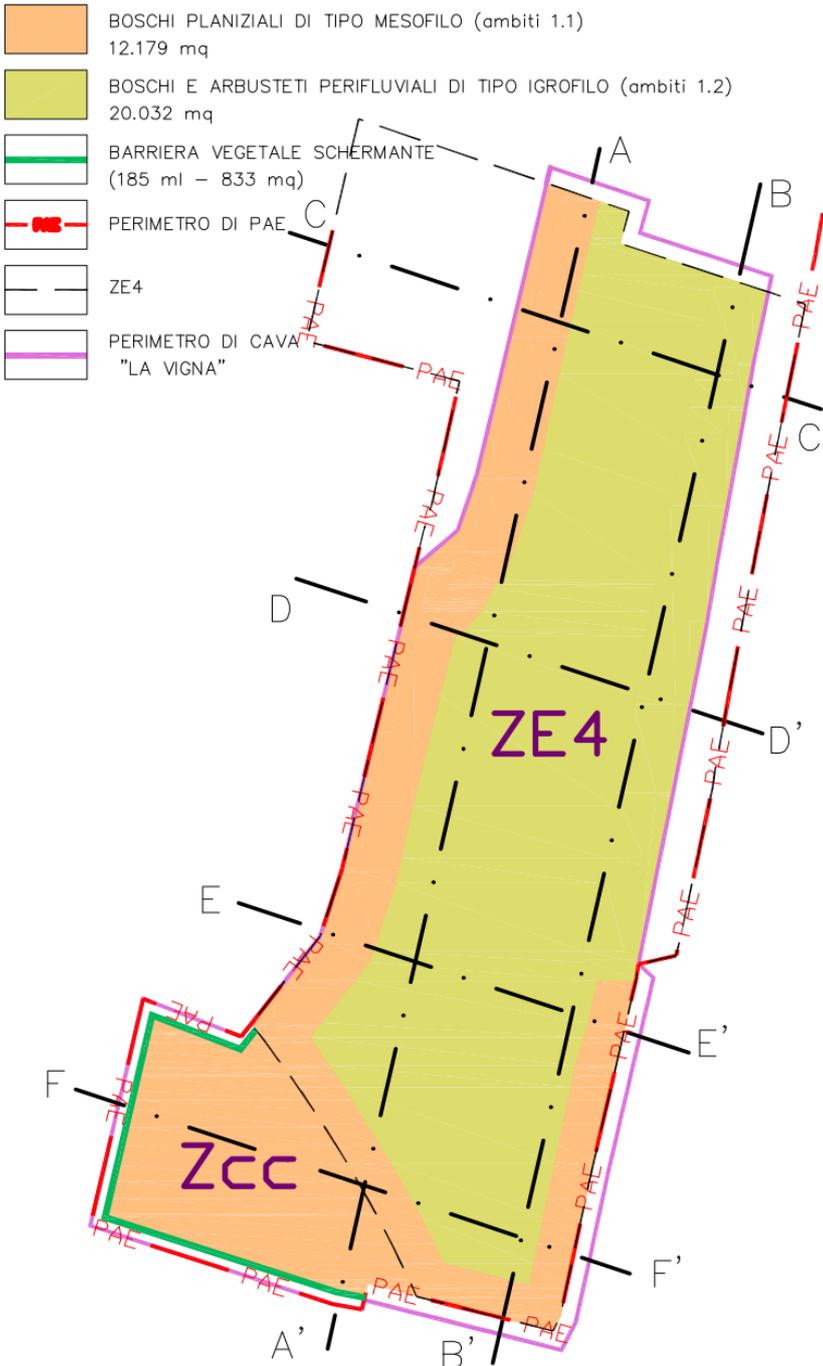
estratto del progetto di sistemazione finale della cava "La vigna" legittimato. Tavole TAVC3a tris (planimetria) e TAVC3btris (sezione)
